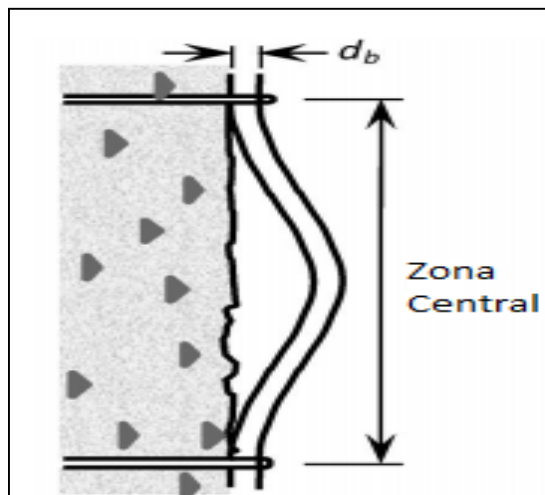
Tipo de falla probetas sin confinamiento central, doble empotramiento en estribos de zona externa
